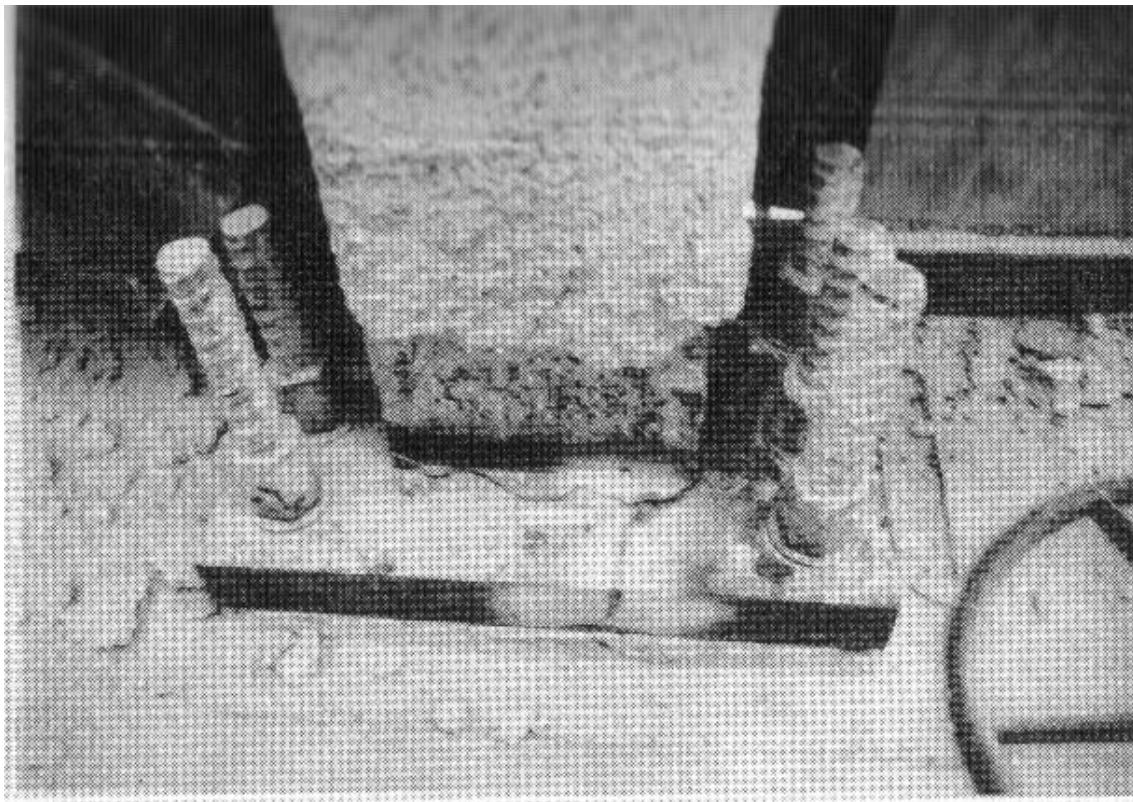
El fisuramiento se inicia en el pie de la columna y posteriormente se extiende por toda el espesor de la plancha. Ref. 5
